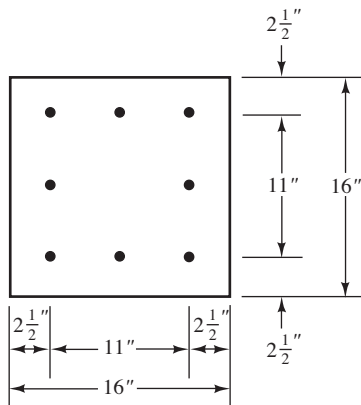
Sección transversal de la columna del Ejemplo 10.4.
